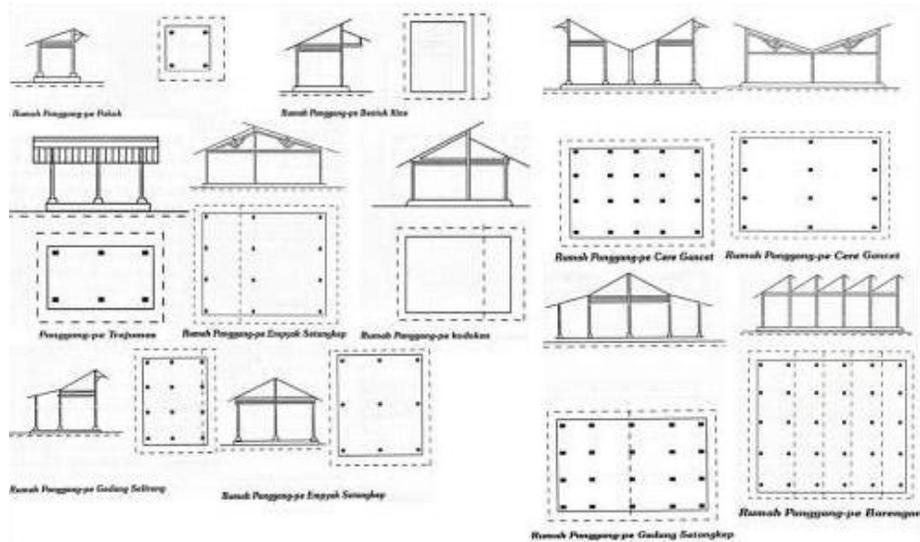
Denah pembagian ruang rumah tradisi Jawa (Dakung 60)
